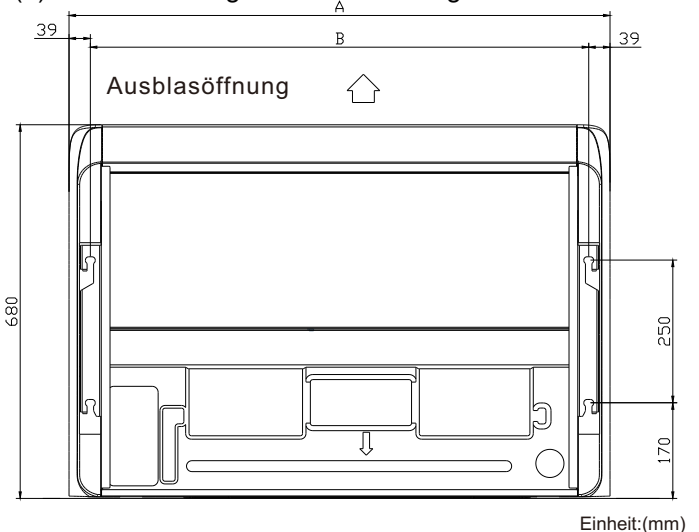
Befestigung der Aufhängungsbolzen
